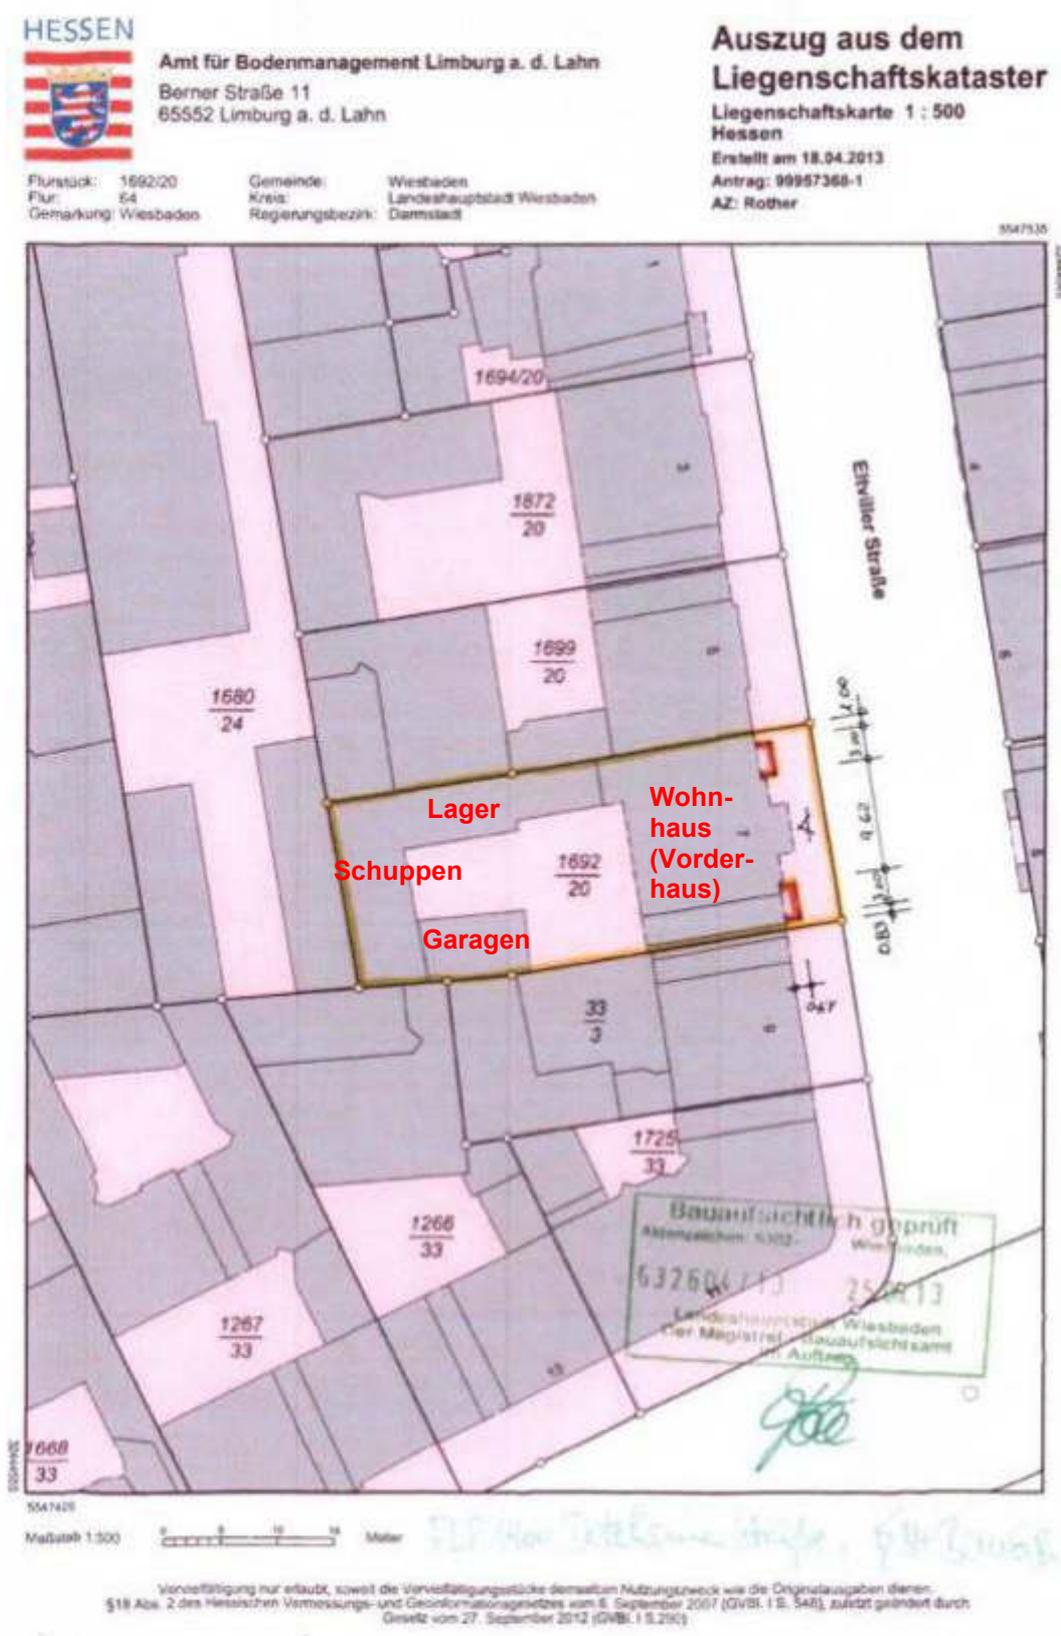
Lageplan; Quelle: Bauakte; Roteintragungen d.d. SV
